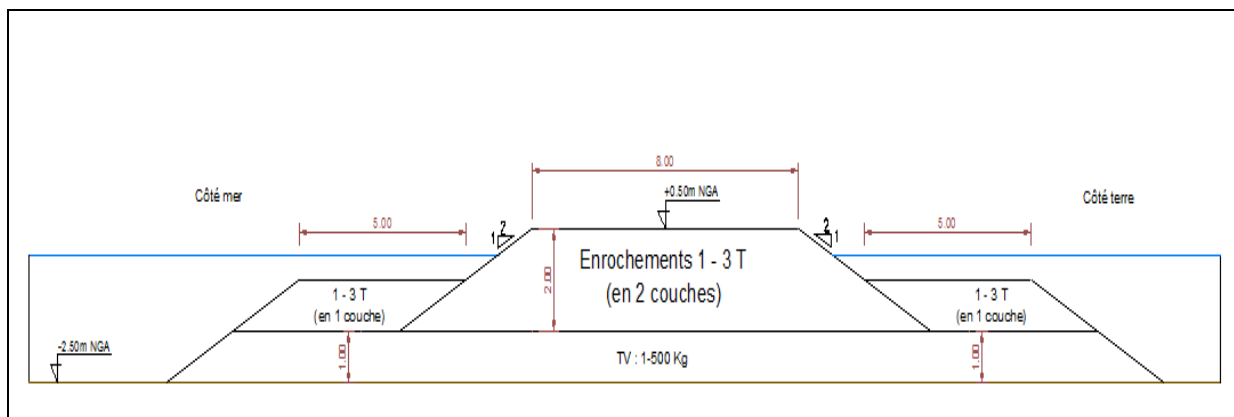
Profil type du brise-lames de la protection n°3 retenue sur Palm Beach.
